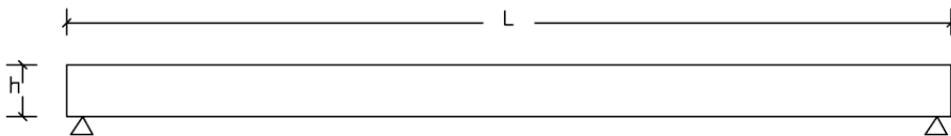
Sección viga definitiva. 2015. CONFEMADERA
